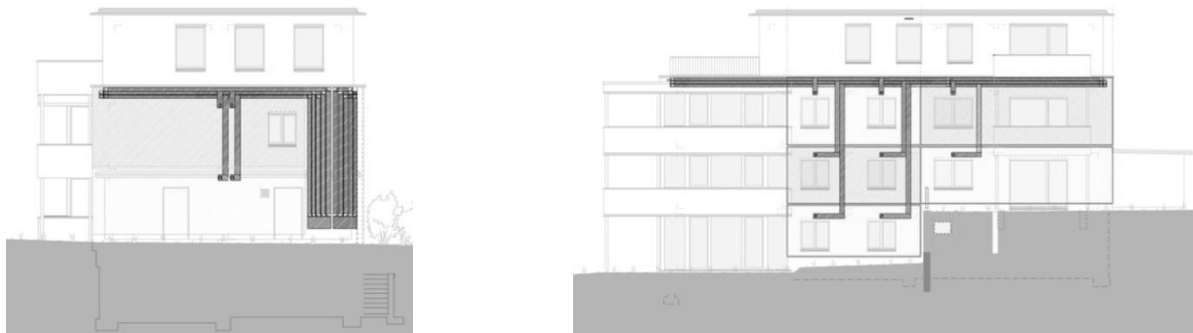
Lüftungskanäle in Fassade und Elementierung
